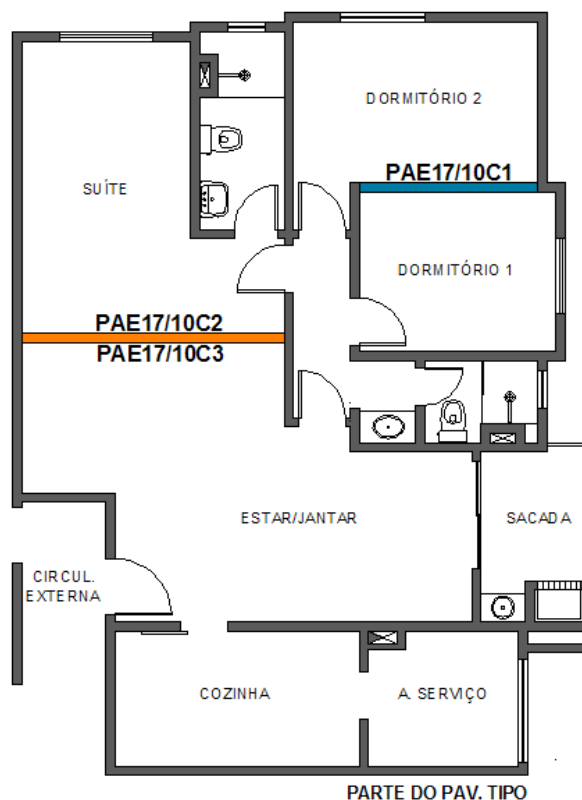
Planta Baixa esquemática parcial do edifício C com a localização das paredes ensaiadas.
